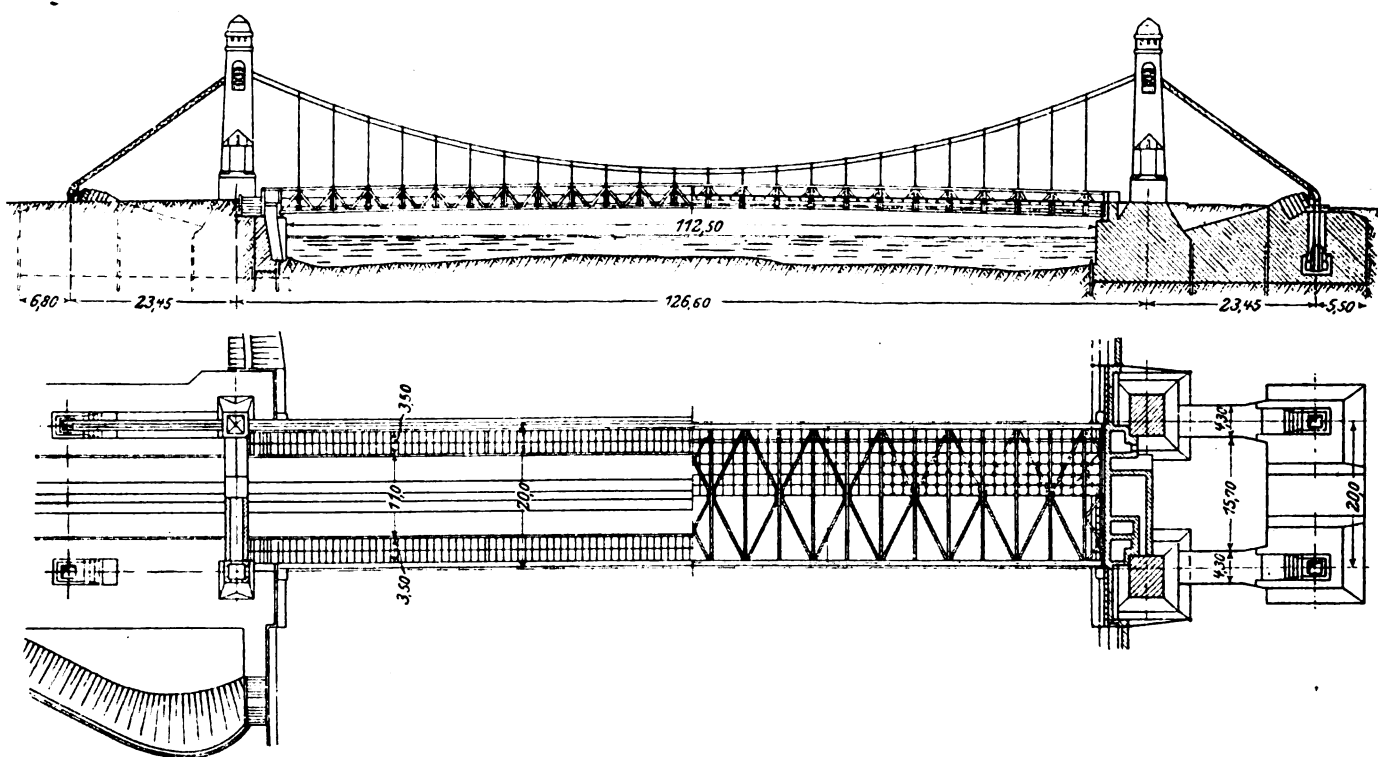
Ponte sospeso sull'Oder - Elevazione e pianta.
